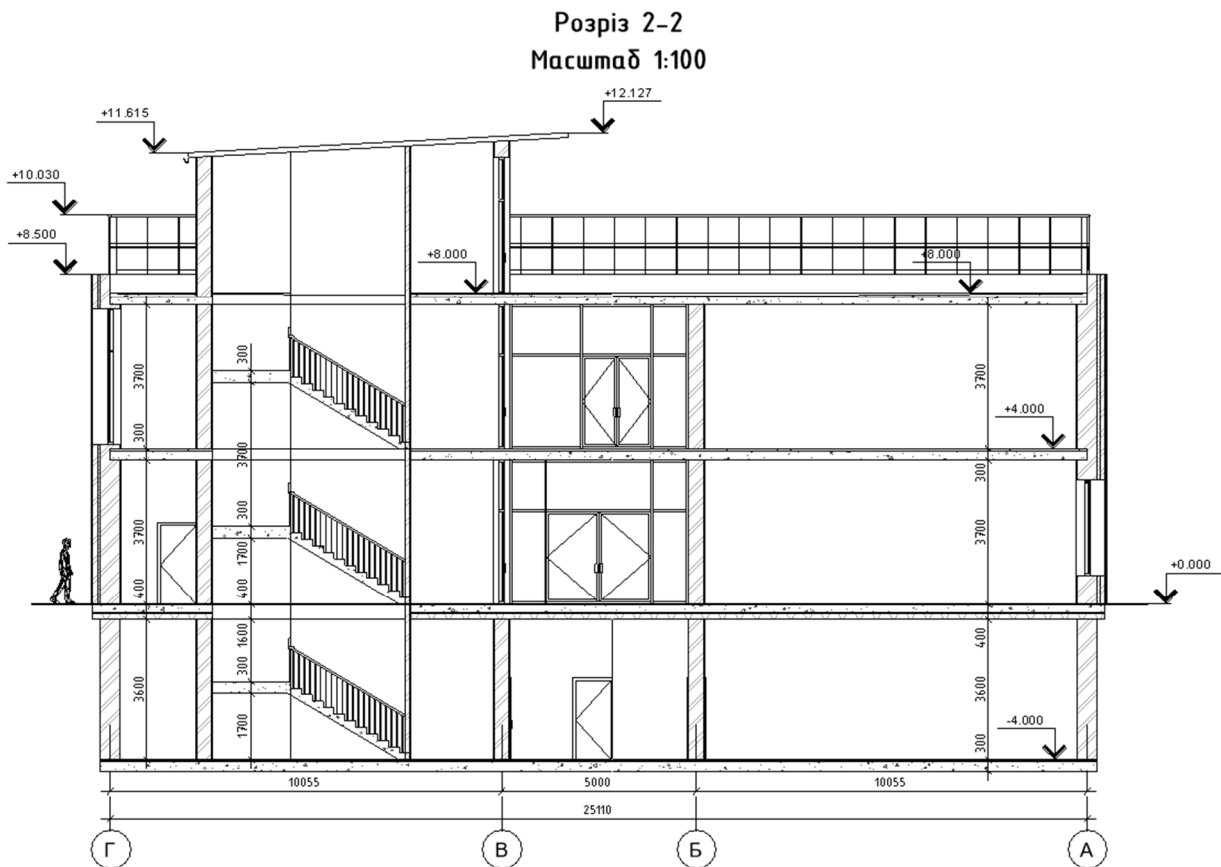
Попереканий розріз будівлі по головним сходам
